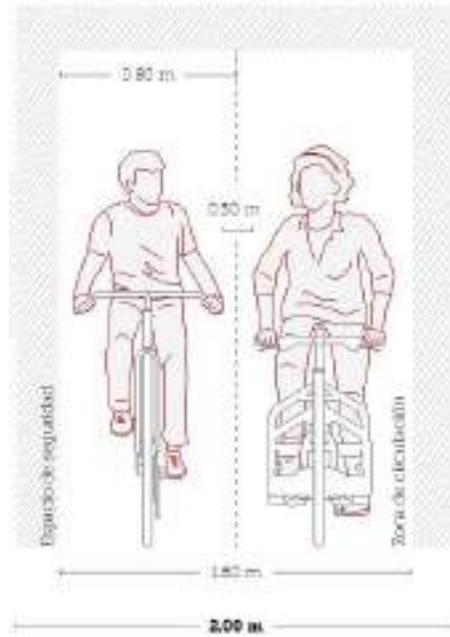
Espacio requerido para una vía unidireccional con adelantamiento.
